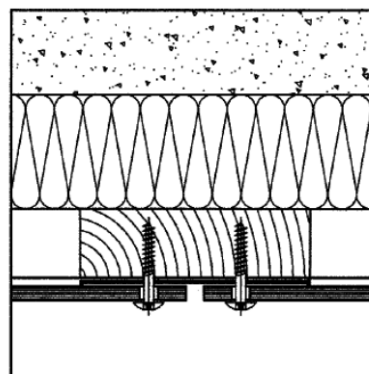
Angle extérieur (vue en coupe horizontale)
